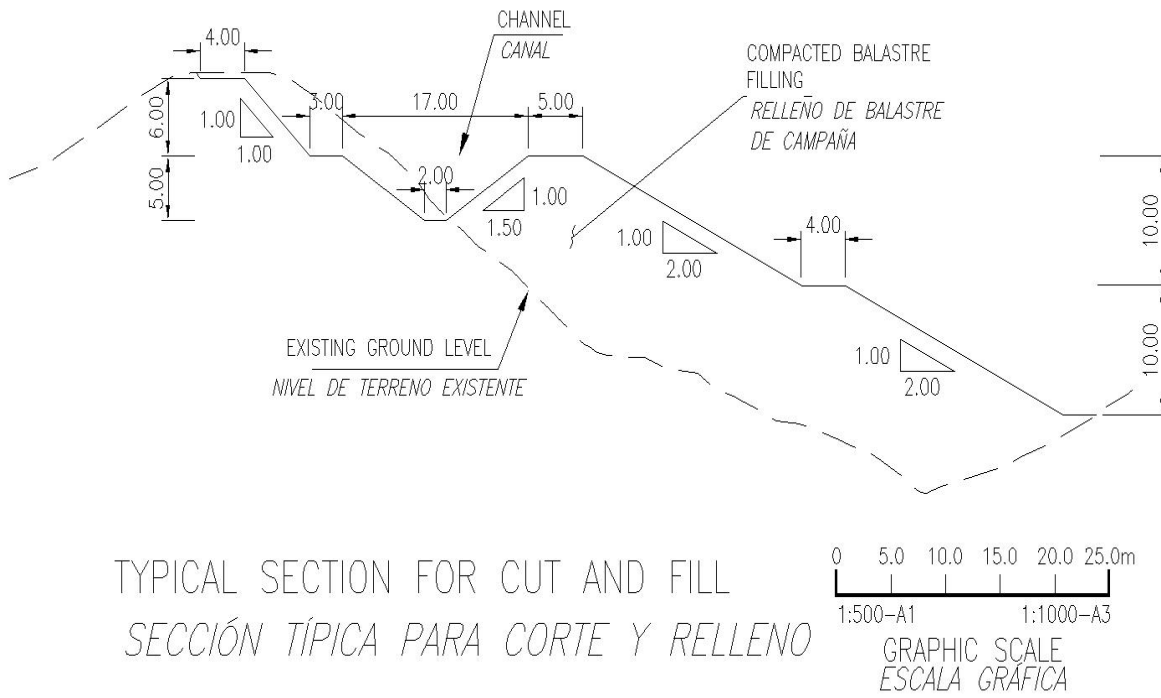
Sección tipo canal de desvío Arroyo Palo Verde.
